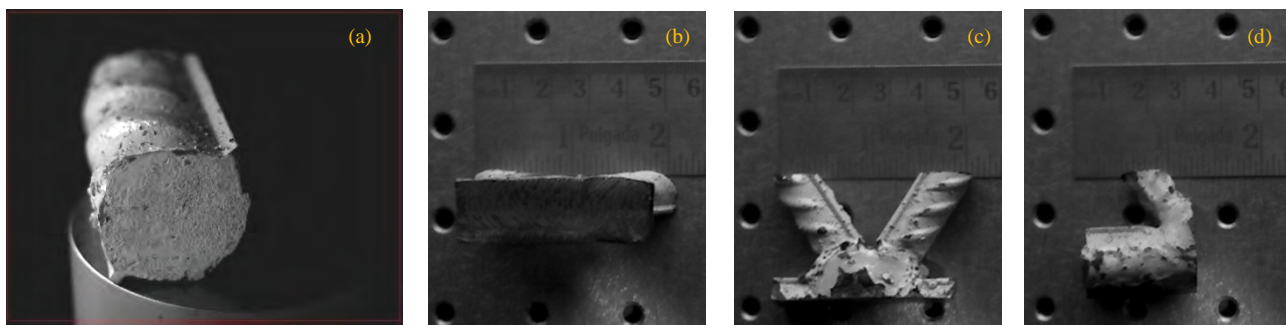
34 (a) Muestra de barra principal de acero nervado obtenida de la estructura colapsada. (b) Vista inferior del corte longitudinal sobre punto de soldadura. (c) Vista lateral de la zona de soldadura. (d) Muestra en corte transversal de la zona soldadura.
